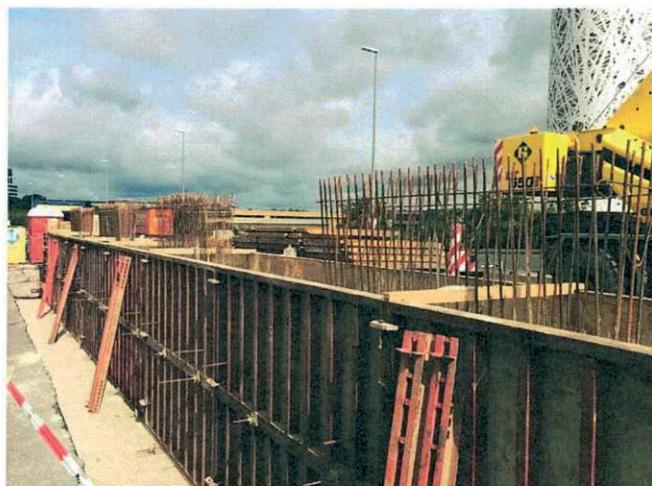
Mise en place du blindage pour les fondations des piles P2 et P3
